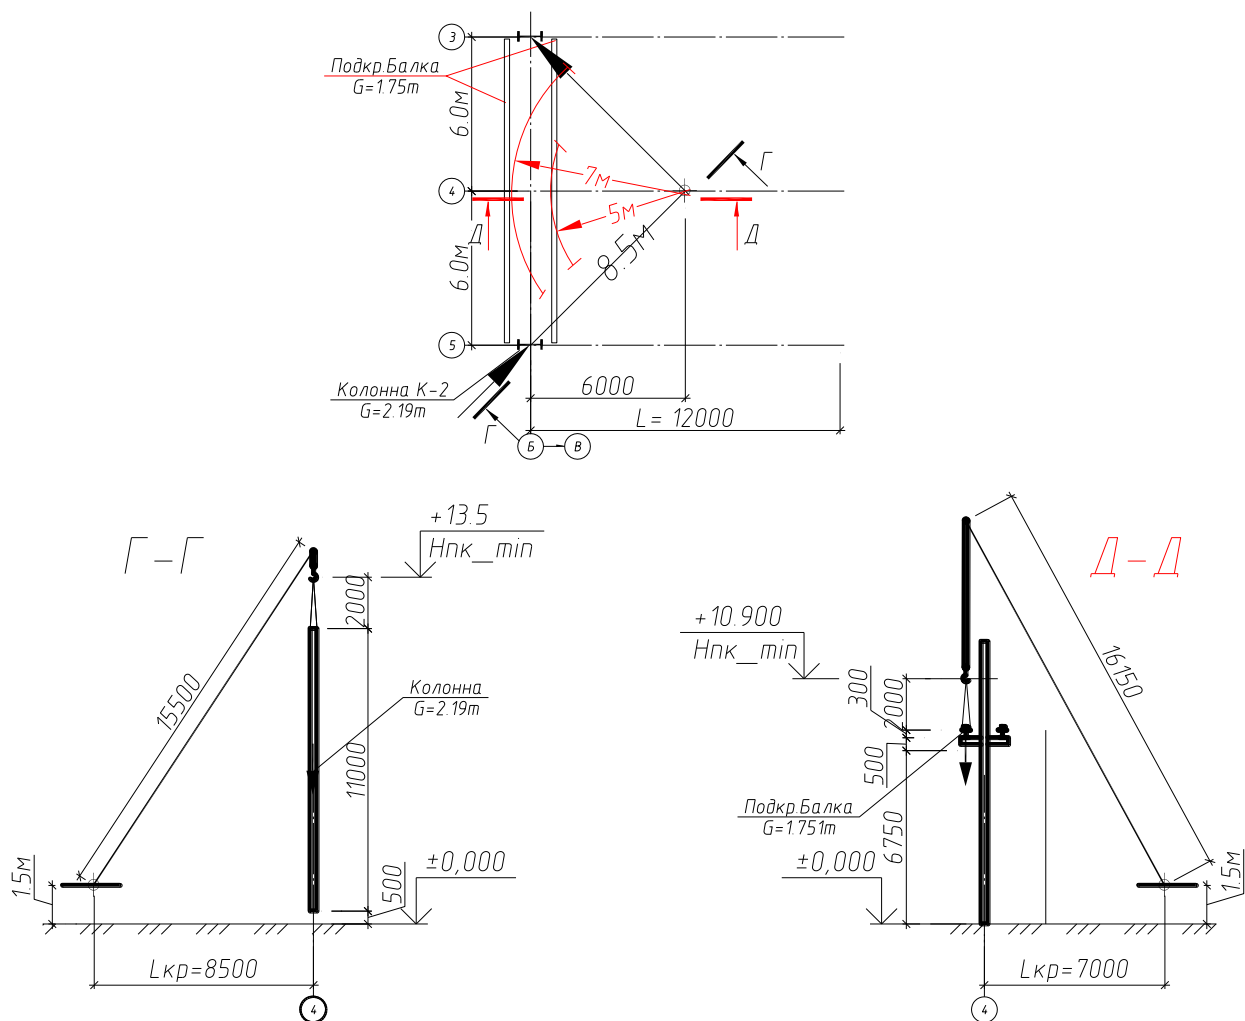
«К подбору крана при монтаже колонн и подкрановых балок» [7]
